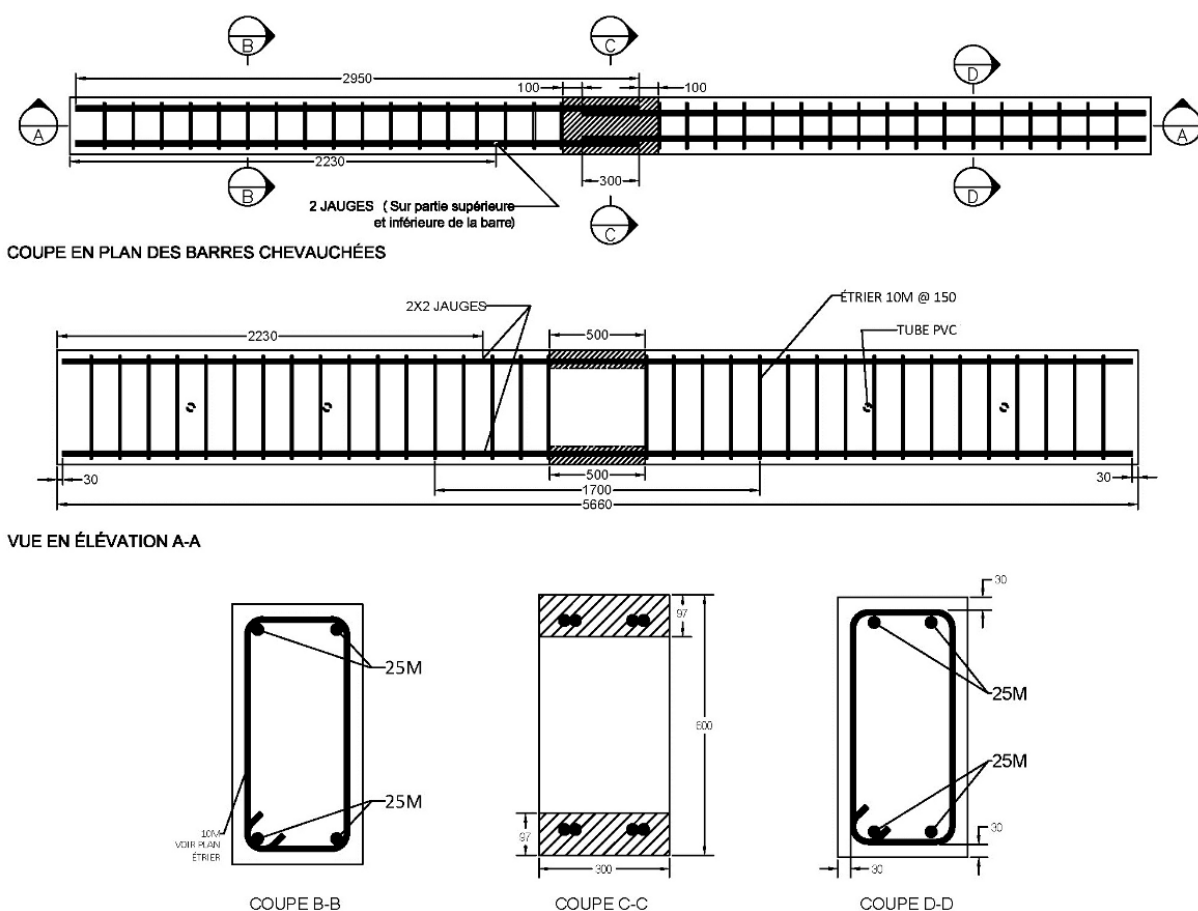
Dimensions et détails d'armature des spécimens de poutres cycliques
